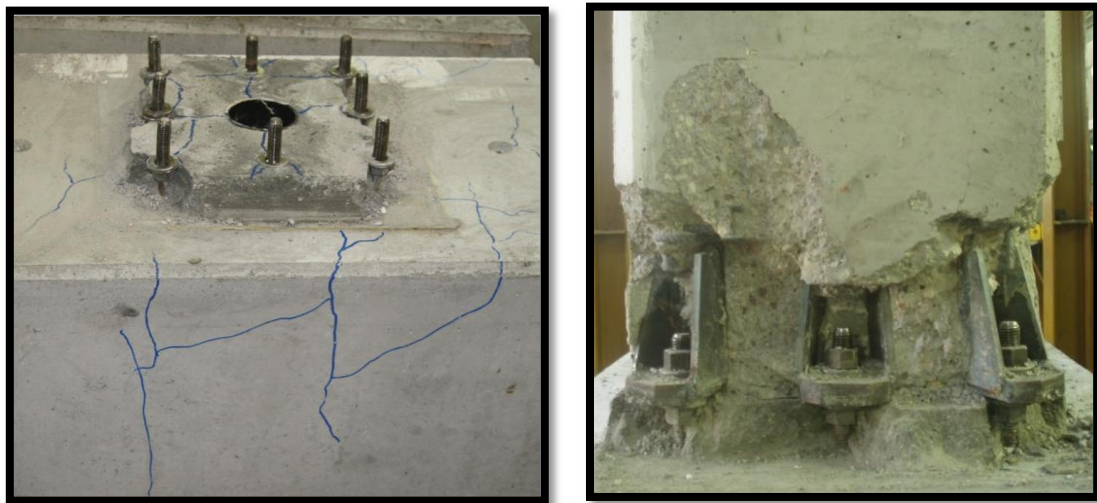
a) Fessure all'interfaccia pilastro-fondazione e all'interno della fondazione stessa; b) Collegamento al termine della prova
